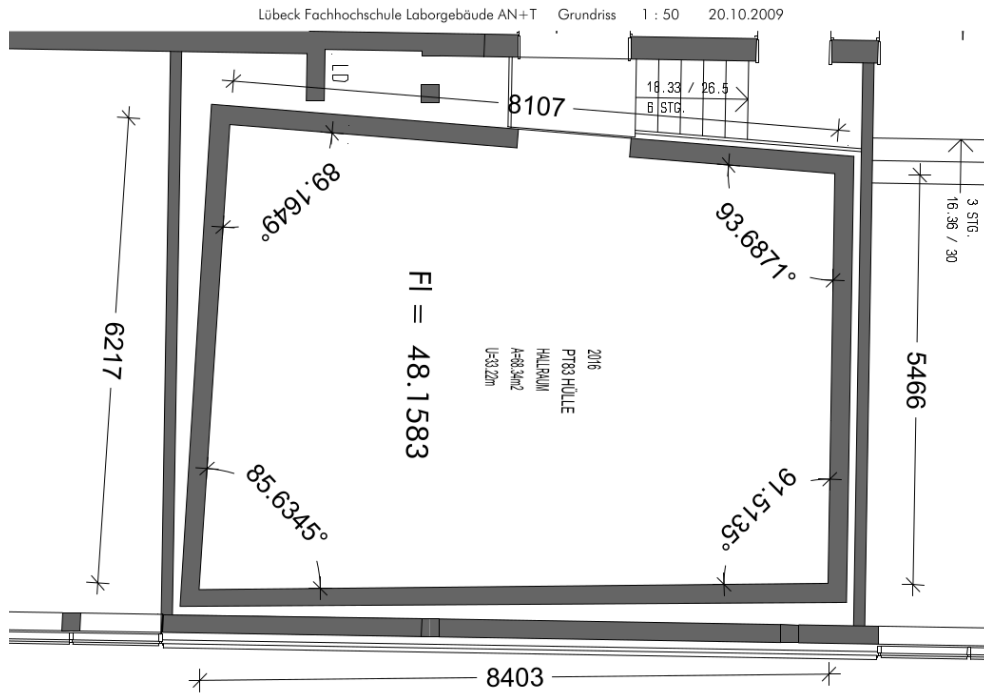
Grundriss des Hallraums der TH Lübeck
